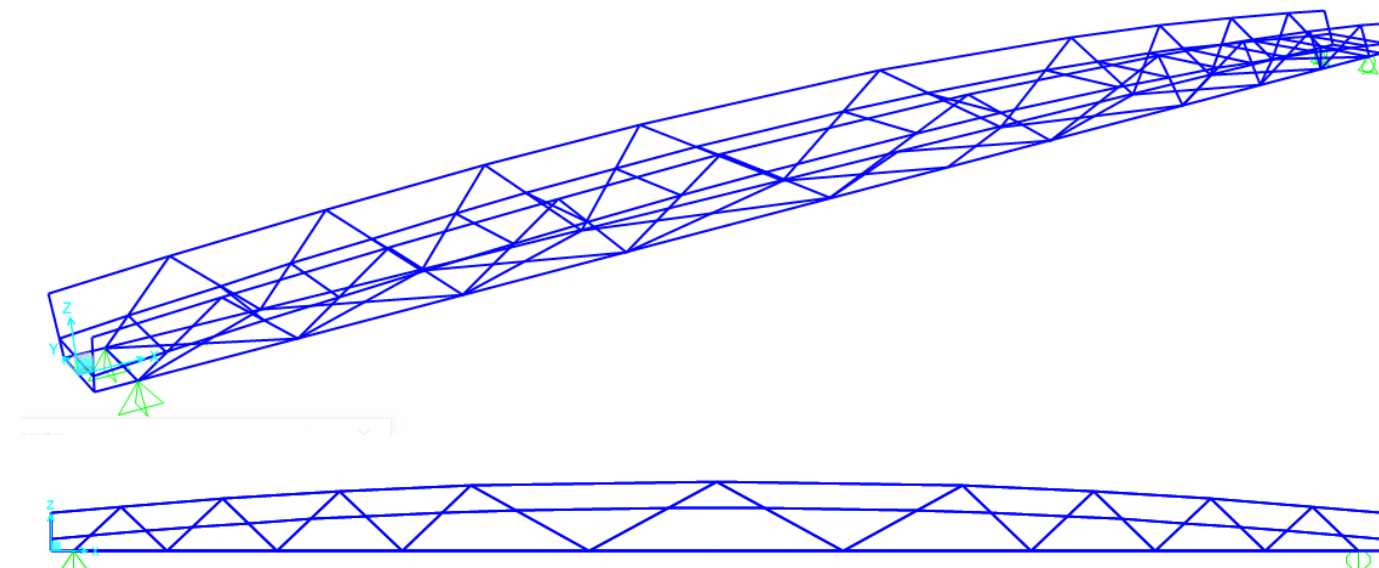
Vistas del modelo estructural desarrollado para la alternativa en celosía. Canto igual a 3,00 m
